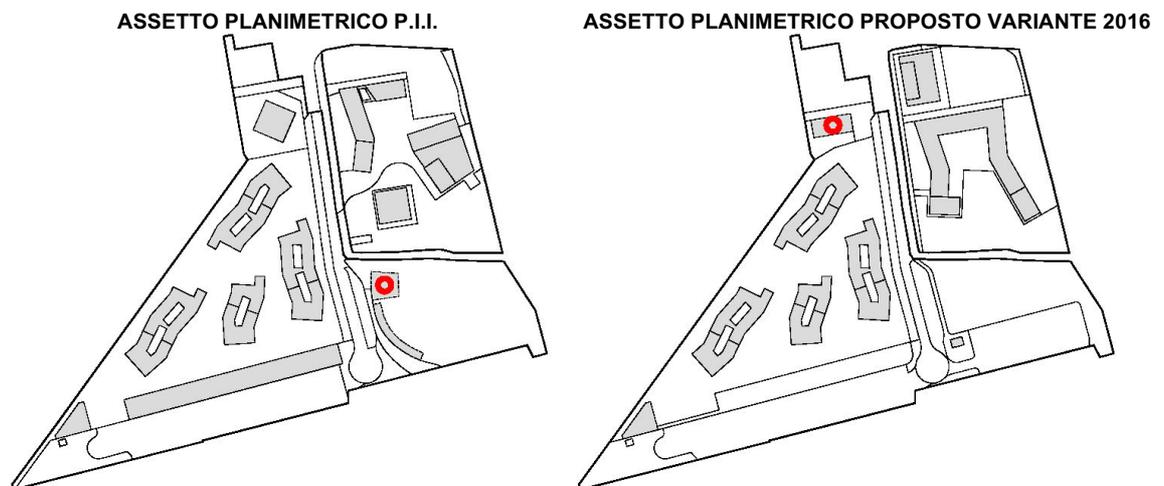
| A sinistra, l'ubicazione dell'asilo secondo la planimetria di P.I.I. e, a destra, la proposta di nuova collocazione prevista dalla variante 2016.
